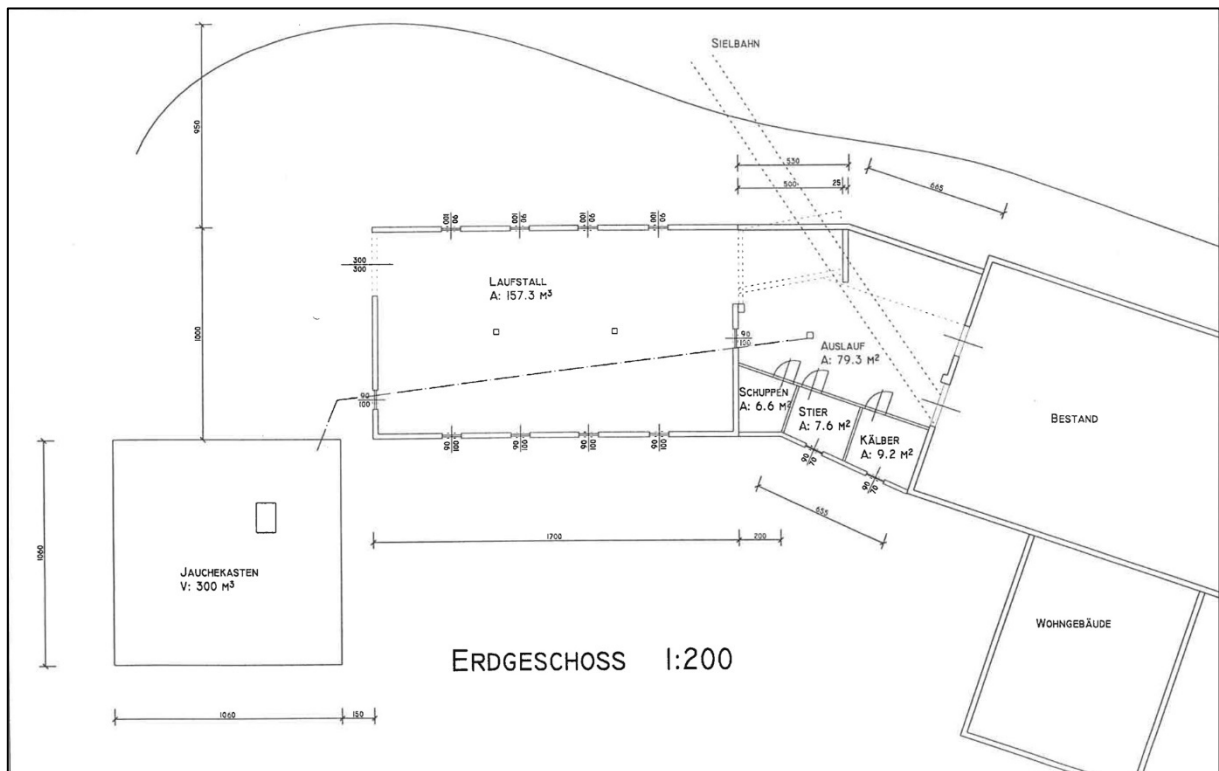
Einreichplan 1999; Grundriss des Erdgeschoßes. Der projektierte Jauchekasten mit 300 m³ Volumen ist nicht realisiert worden. Der ergänzend zum Laufstall erforderliche Melkstand wurde im Altgebäude eingerichtet.
